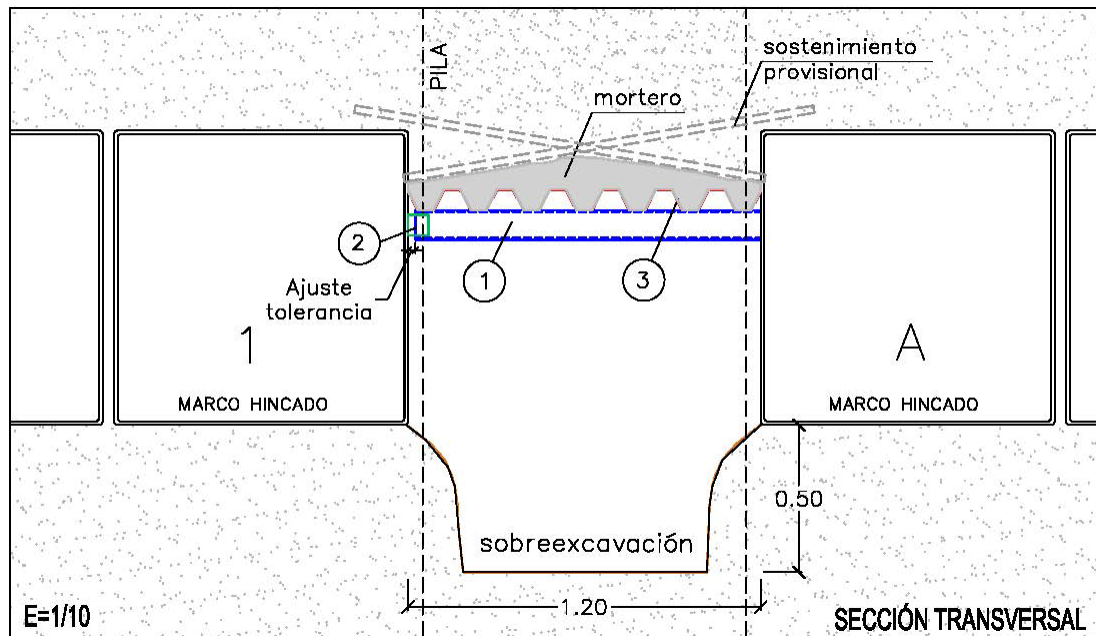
Detalle del sostenimiento zona entre pilas pilote
